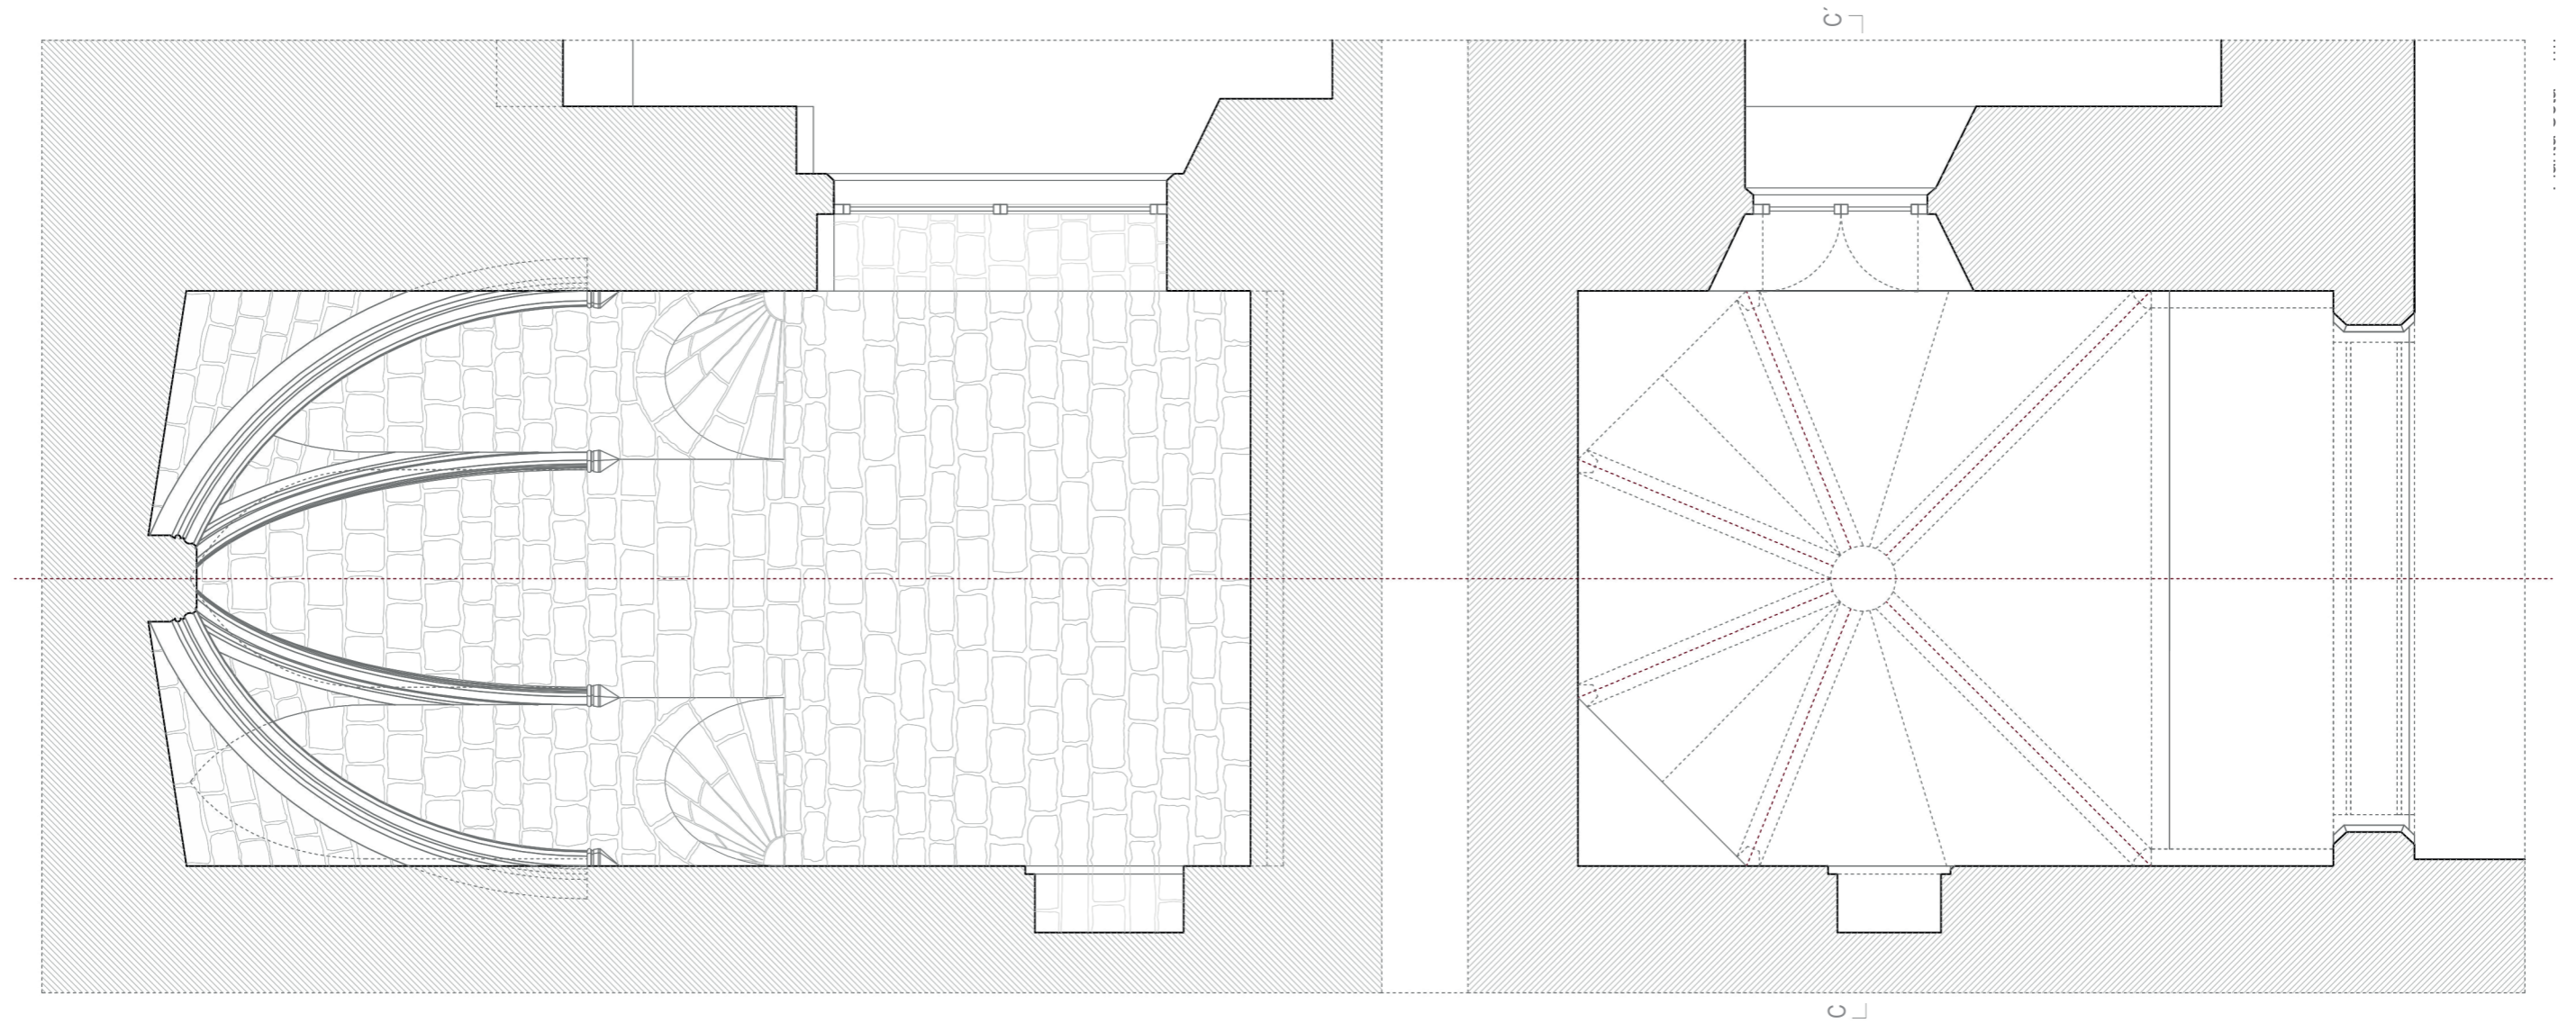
Planta y sección de la capilla a escala 1:50 (Dibujo propio)
